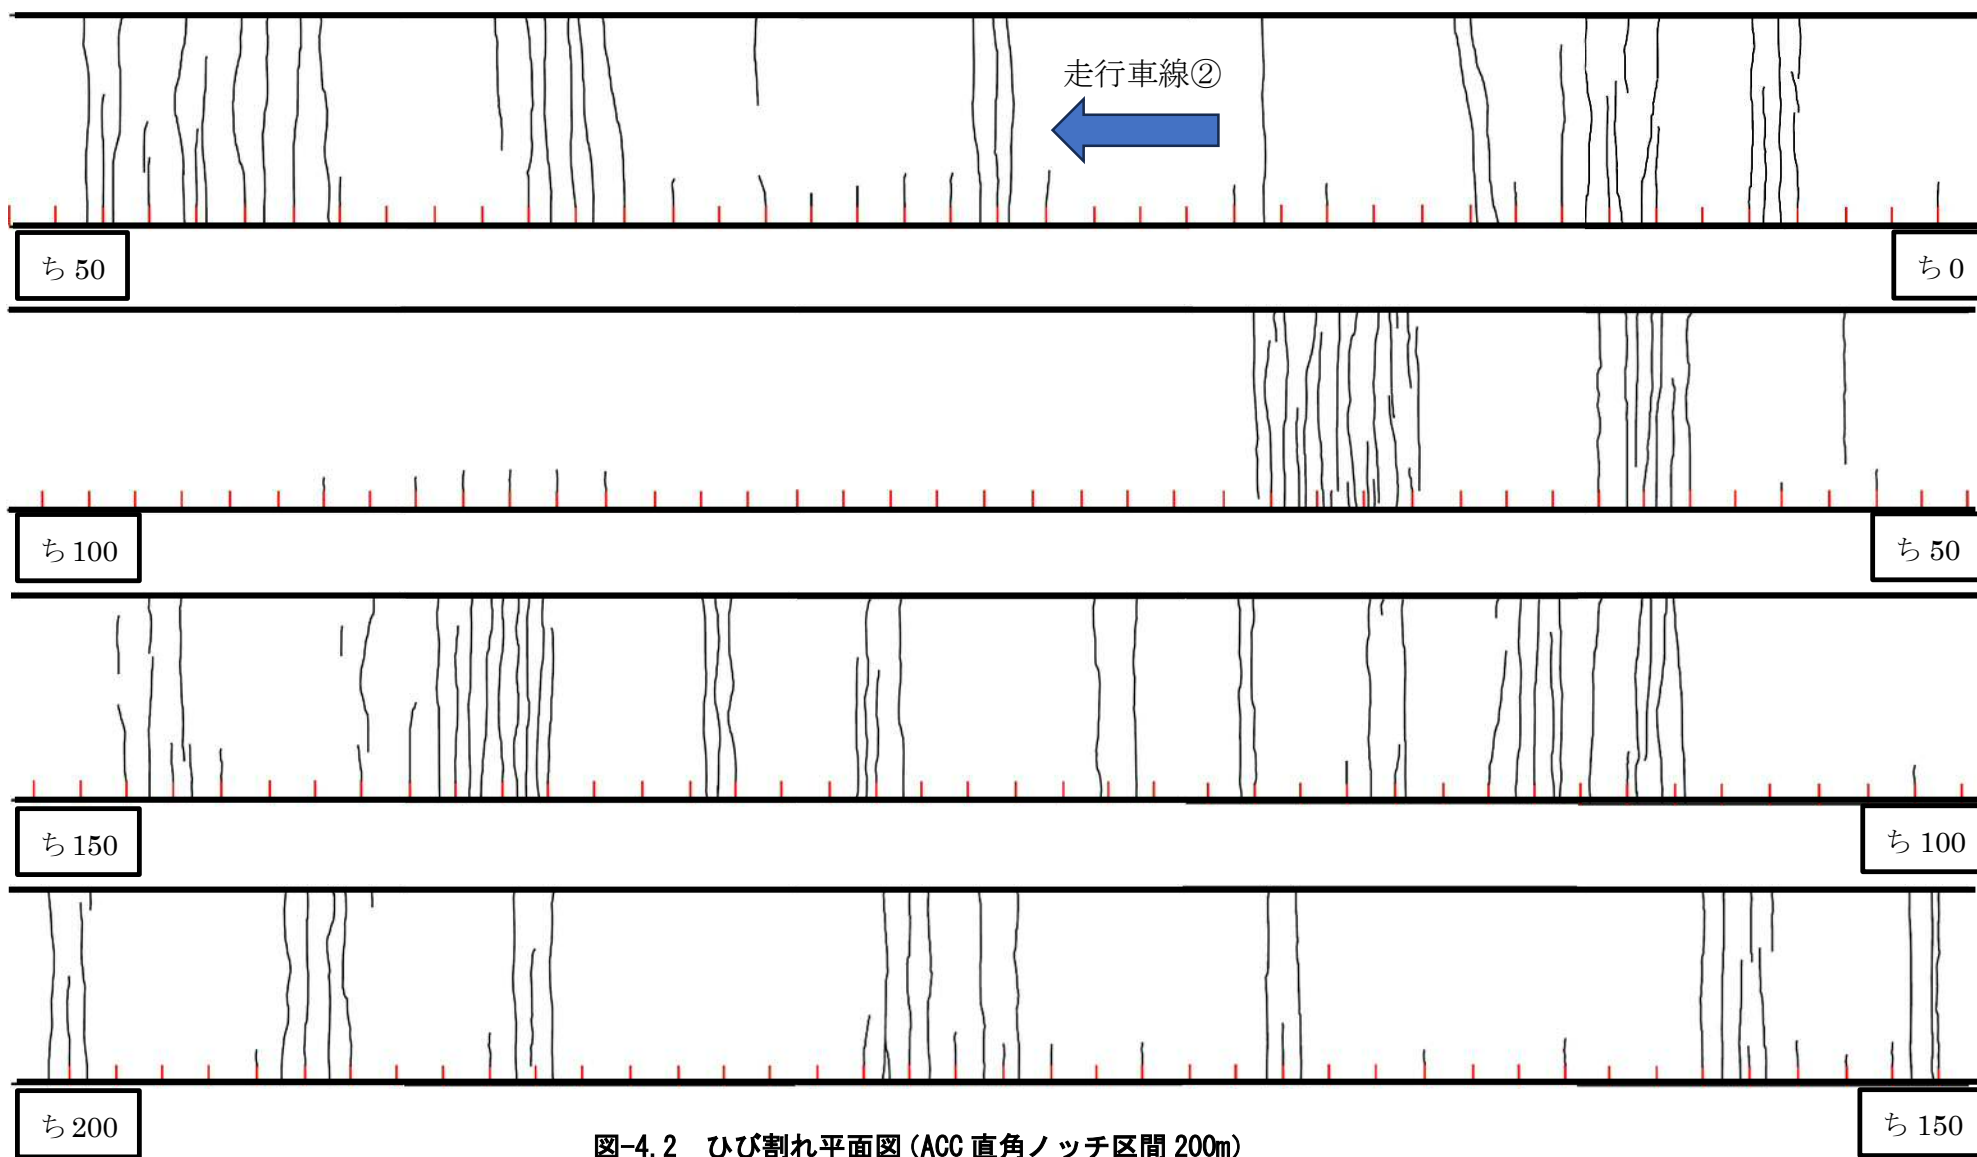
ひび割れ平面図 (ACC 直角ノッチ区間 200m)
